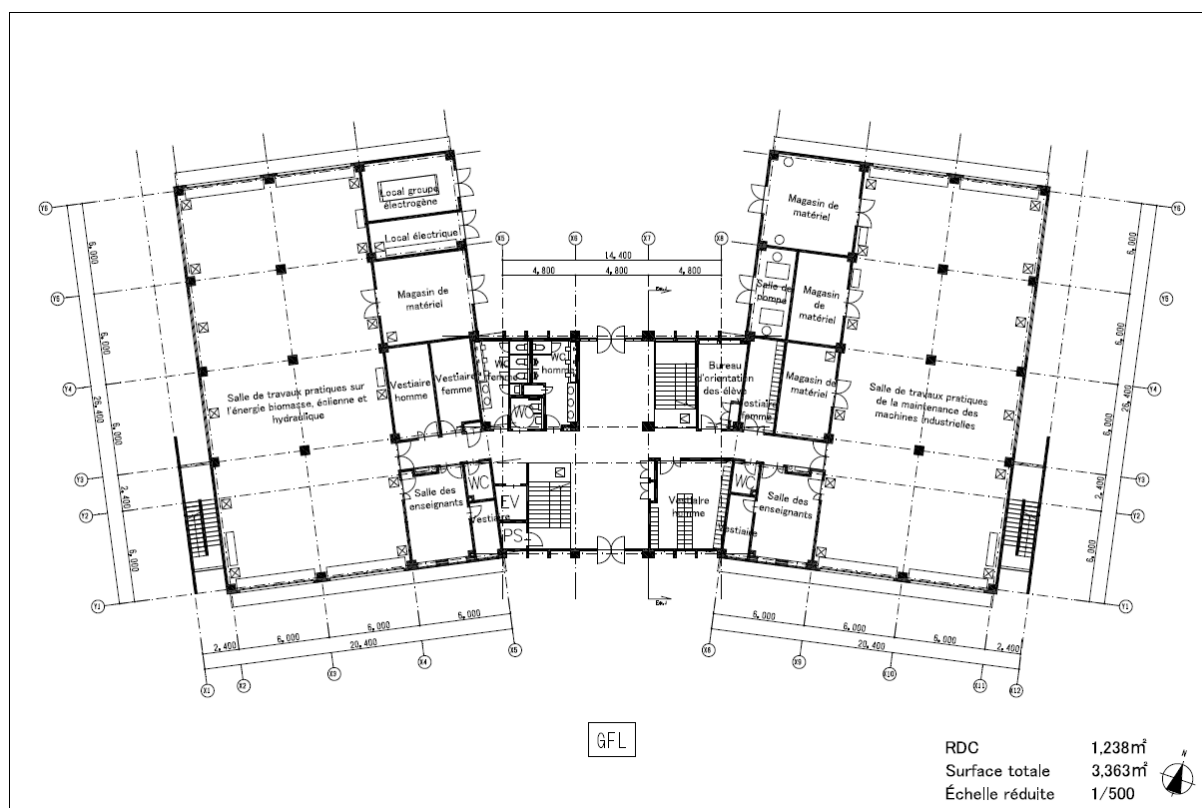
Plan d'étage du bâtiment principal RDC
